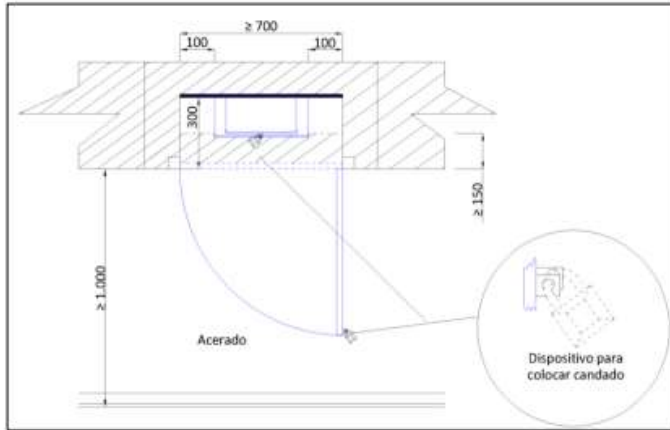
Instalación CGP y CS montaje vertical. Planta.
